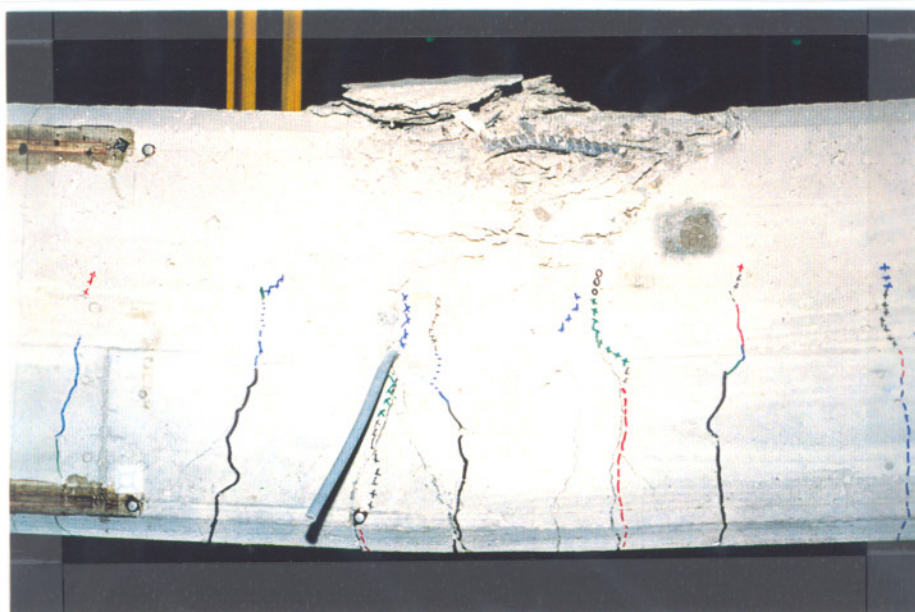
Viga C12. Detalle del pandeo de la armadura superior.
